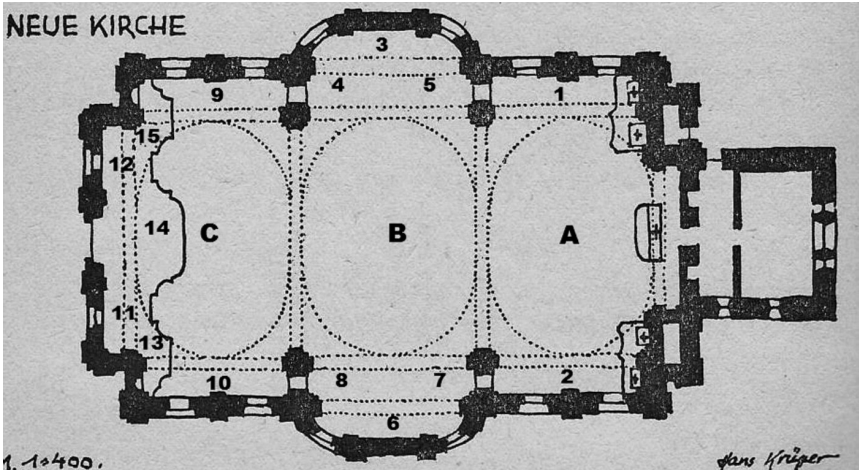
Grundriss der Tiengener Kirche mit Position der 15 Embleme.
